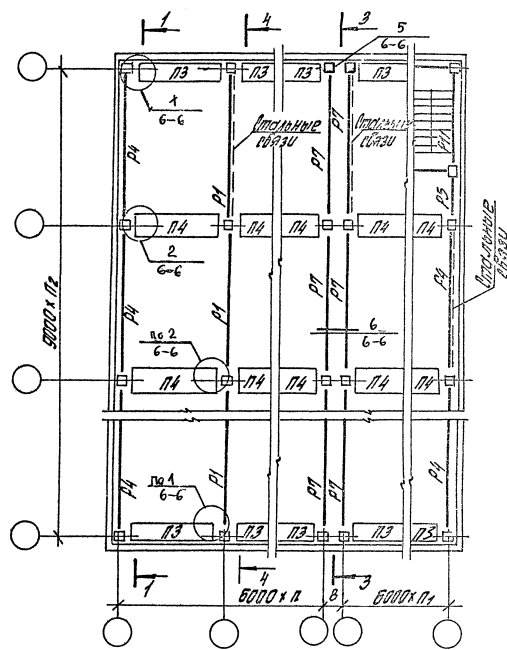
Схема расположения ригелей и обвязочных плит в перекрытиях зданий с сеткой колонн 9х6 м
